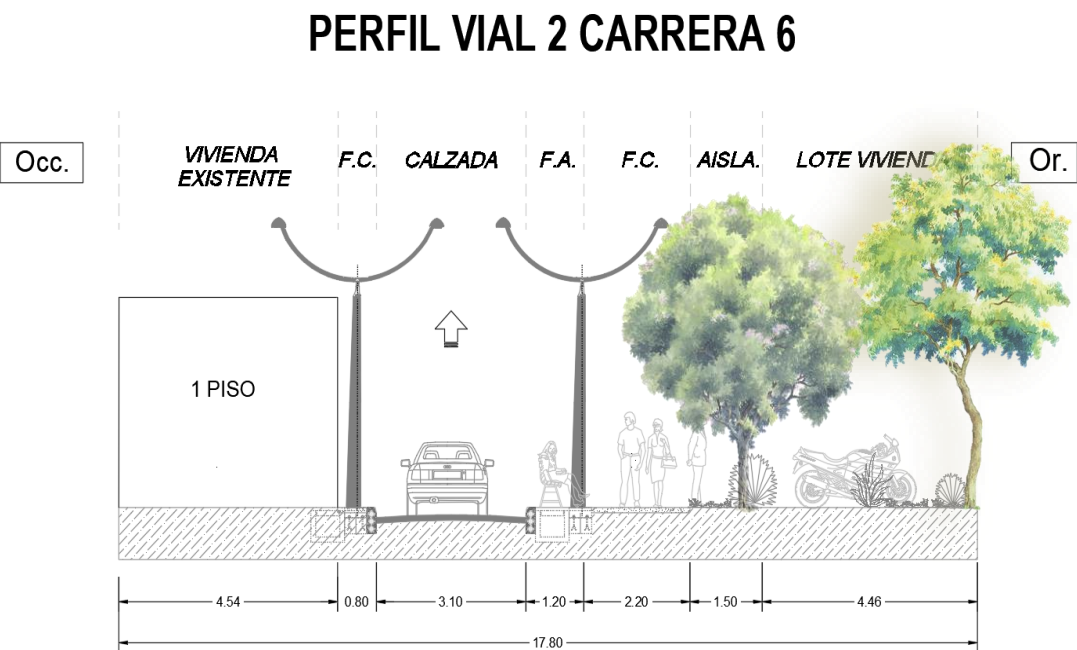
Perfil vial Carrera 6, Cantagallo, Bolívar
